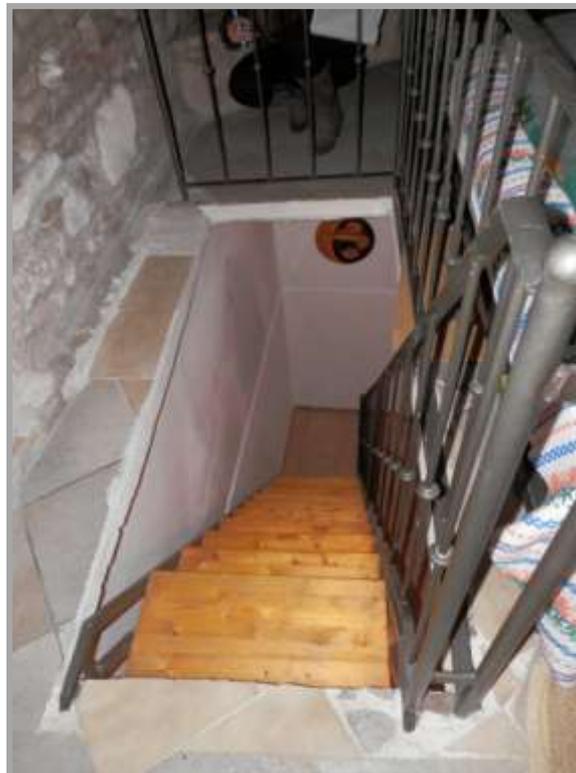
" – Vista delle scale di accesso al piano sottotetto (piano quarto)
